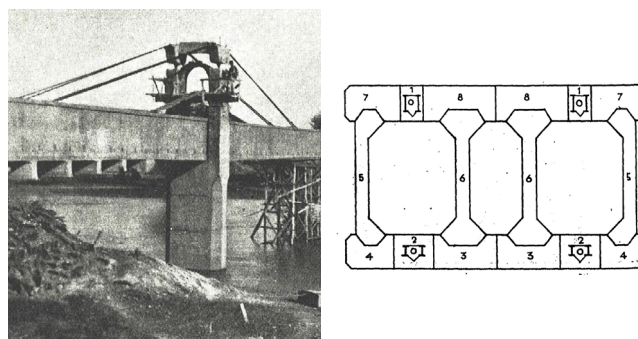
Acueducto de Tempul: Elevación de la cabeza de las pilas (izquierda) (26). Viaducto Martín Gil: Orden de hormigonado de las roscas (25).
